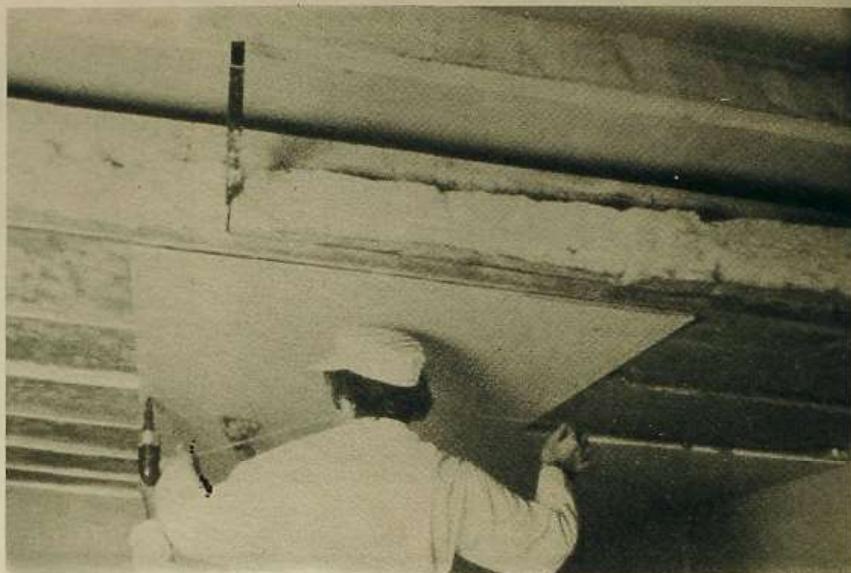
Estructura portante oculta. Las placas se atornillan al entramado metálico. El posterior sellado de las juntas permitirá obtener un techo continuo.
